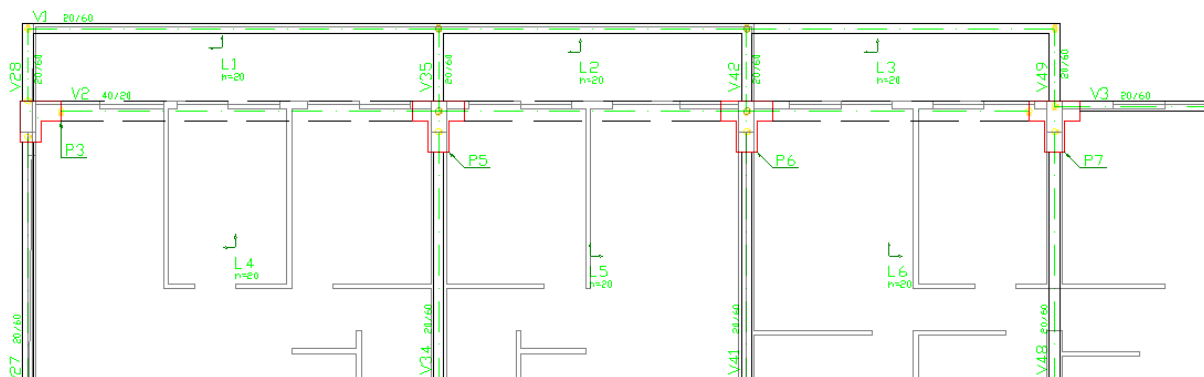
Trecho em planta do pavimento PT9 na Solução Convencional
